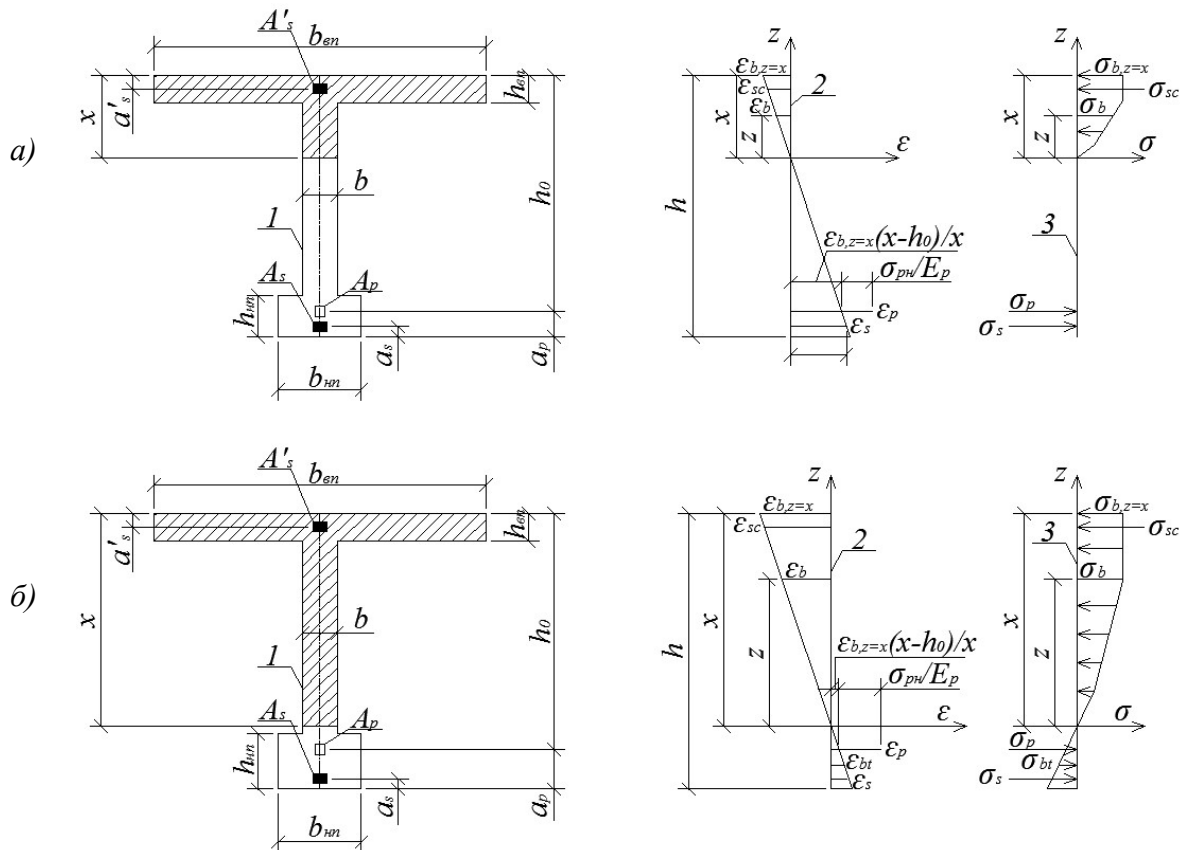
Схемы к деформационному расчёту изгибаемых железобетонных балок со смешанным армированием:
